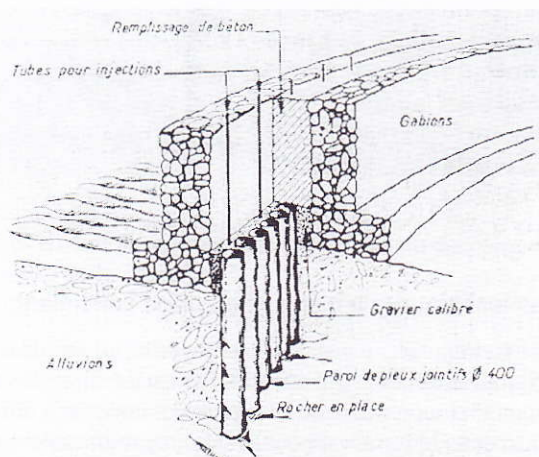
Emploi de pieux sécants pour la constitution d'un écran de soutènement (prébaradeau amont du barrage de l'Aigle, d'après Galabru, 1963).
